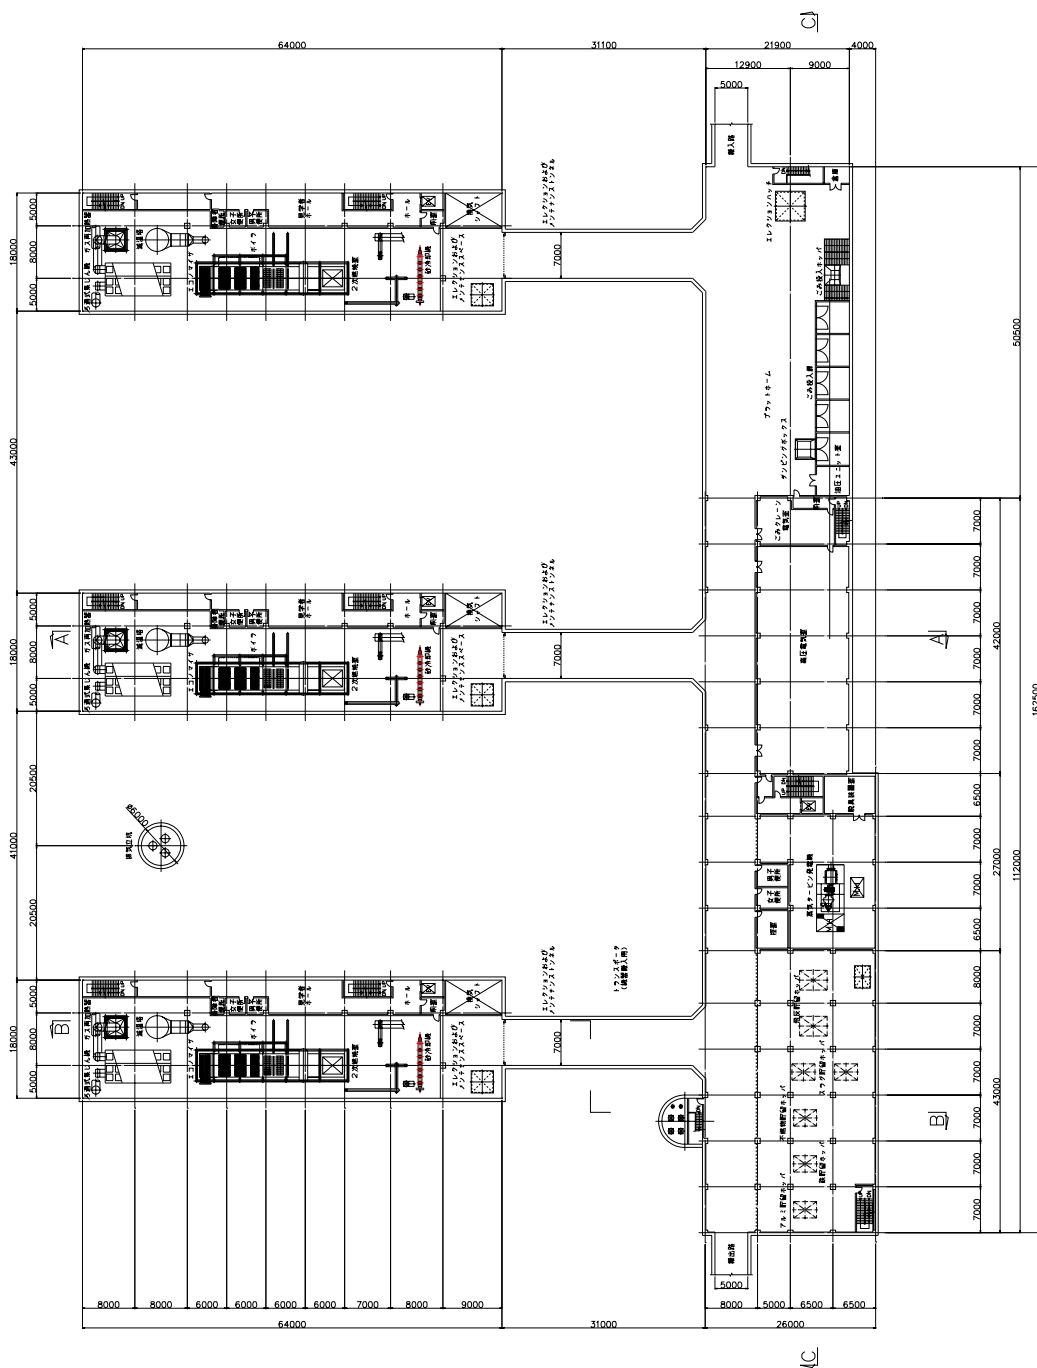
横型（横坑式）ガス化溶融機械システム B4FL 機器配置平面図
